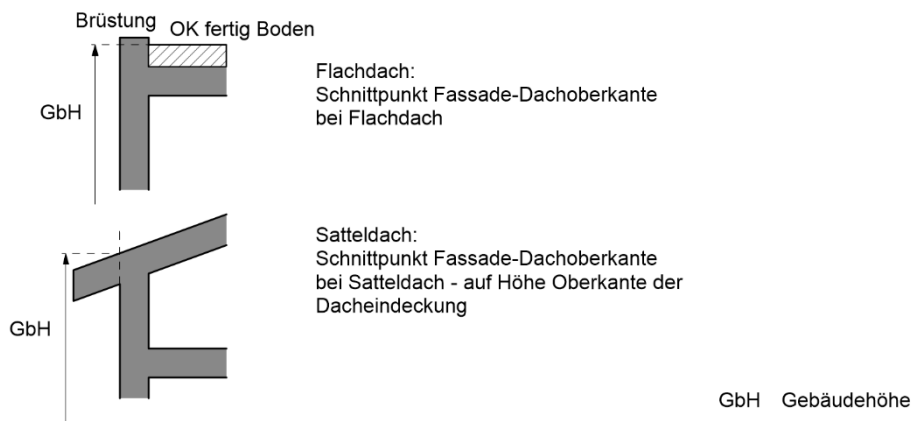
Schnittpunkt „Fassadenoberkante“
